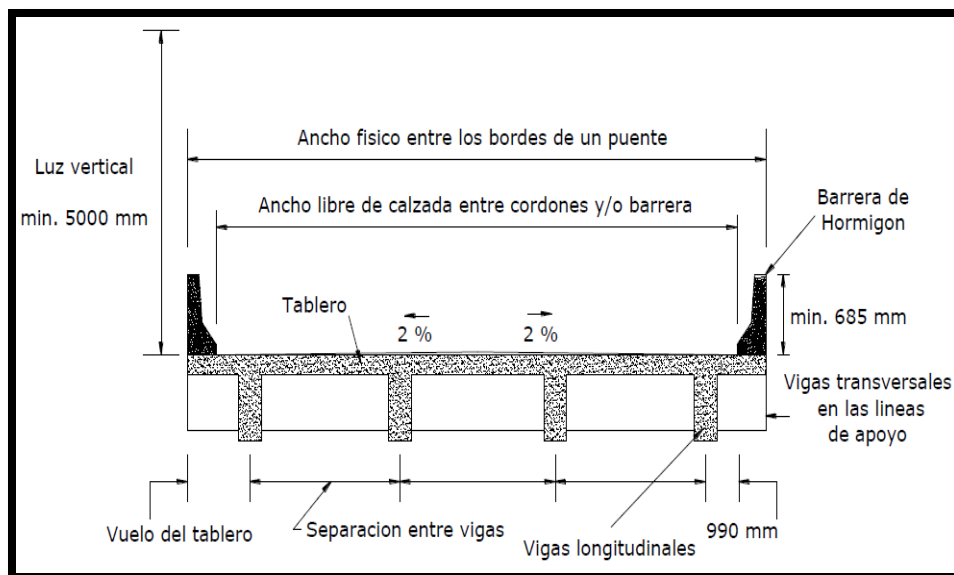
Tablero y estructura portante, puente Viga-Losa
